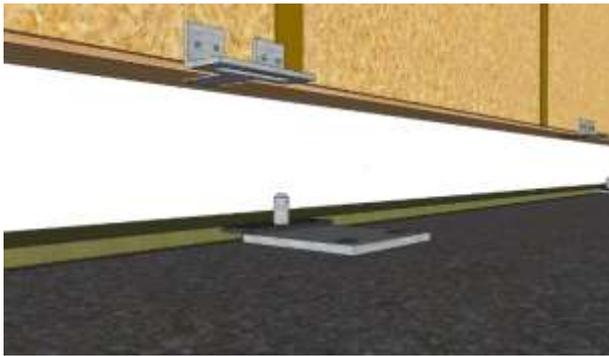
Bride autorisant un déplacement vertical de la dalle +/- 10 mm (mode de pose 2-2)
